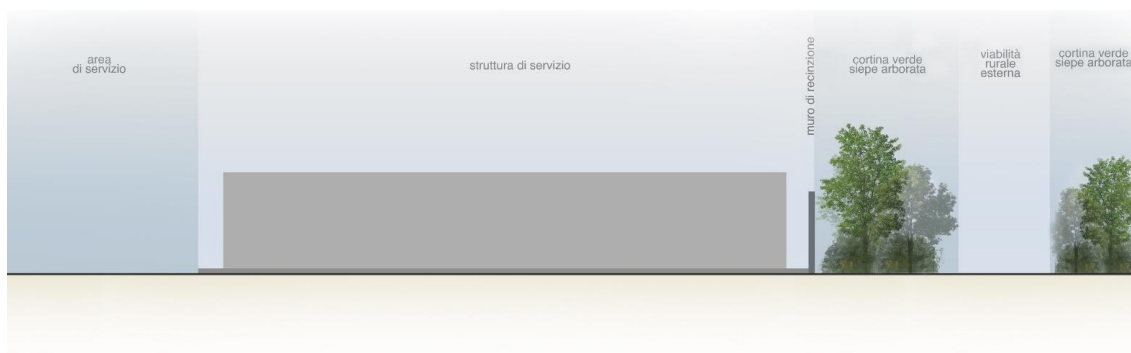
Prospetto n.2 delle opere a verde di mitigazione della SE Terna
